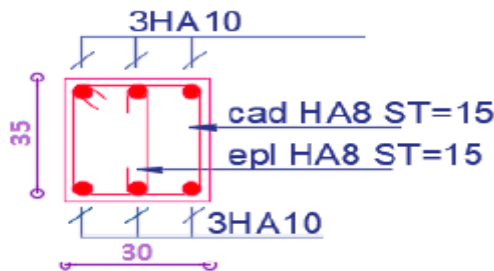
Détaille schéma de ferrailage des poutres de chaînages.
